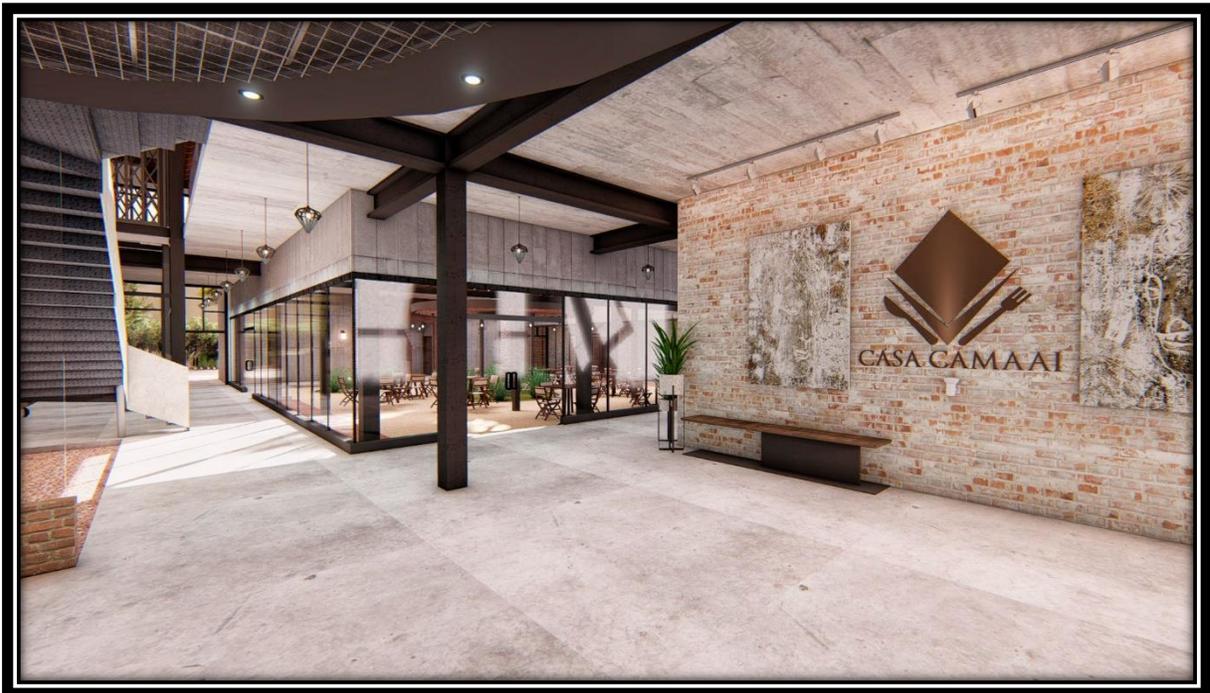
Vista de recepción. Planta baja. Fuente propia.
